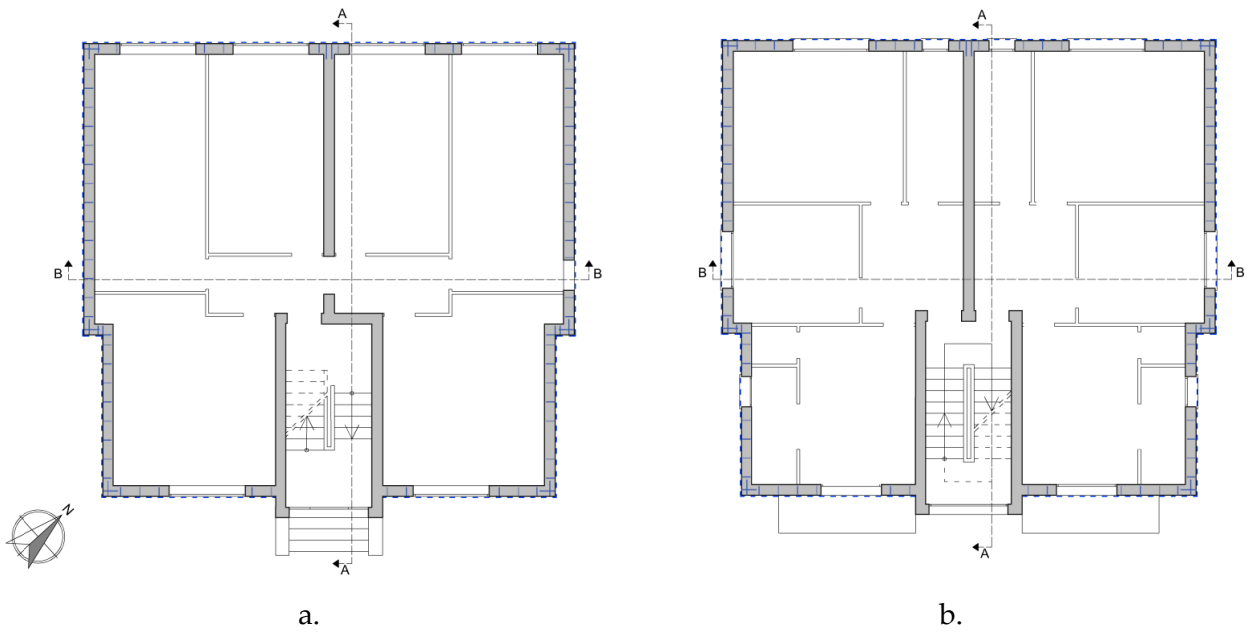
Intonaco armato con rete elettrosaldata su due lati: a) pianta piano terra; b) pianta interpiano.
